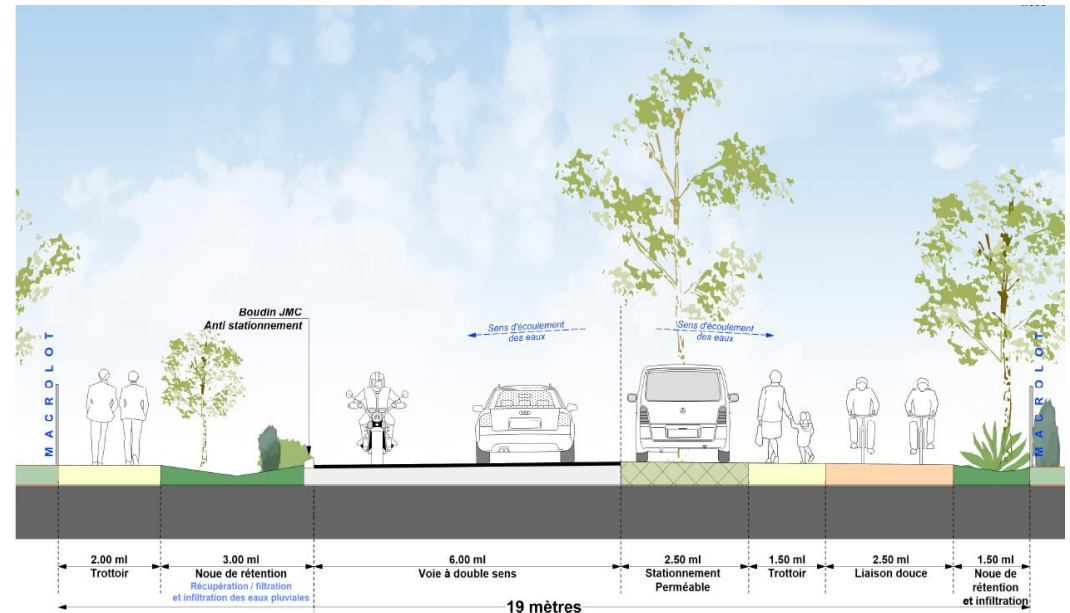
Coupe de voie principale (coupe de principe) après modification
